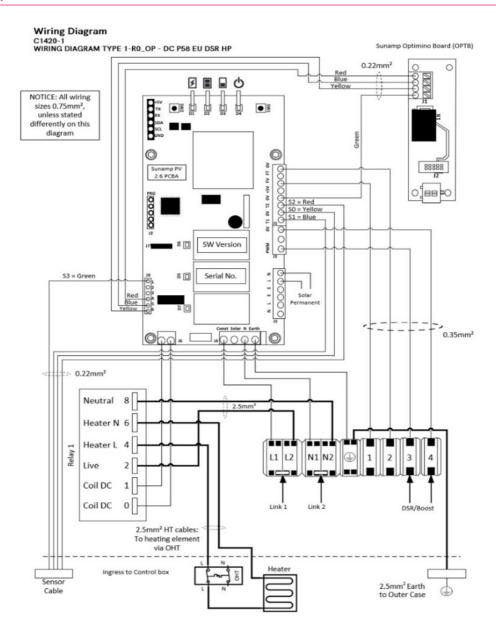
Vue d'ensemble du câblage du Flextherm Eco G2 D Heat Battery
